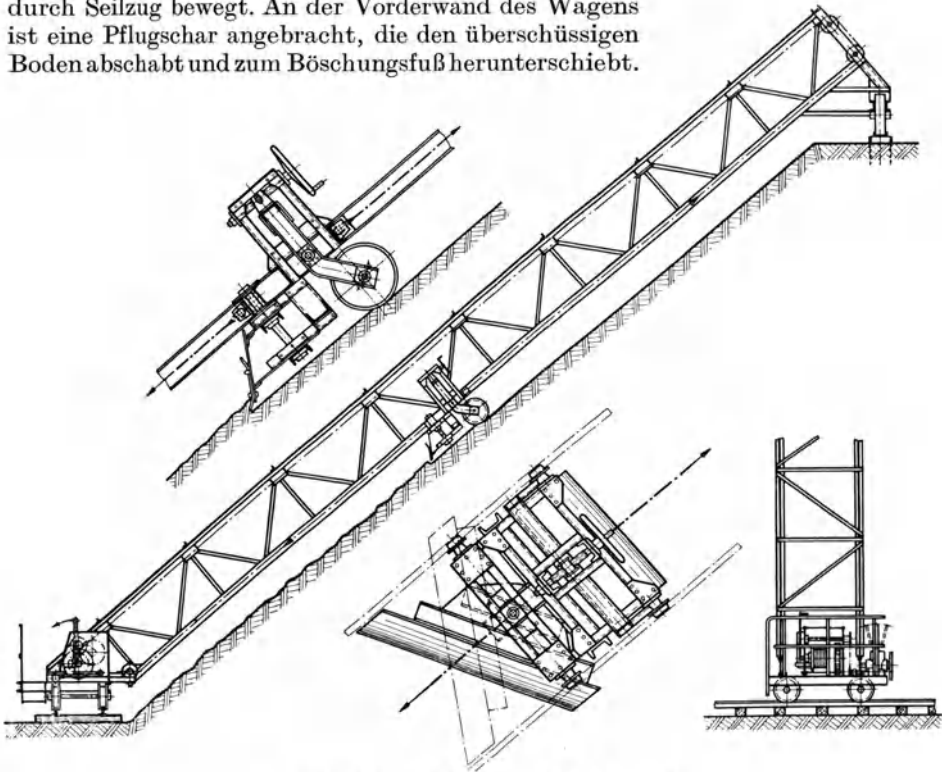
Kleiner Planierapparat (Dinglerwerke).
